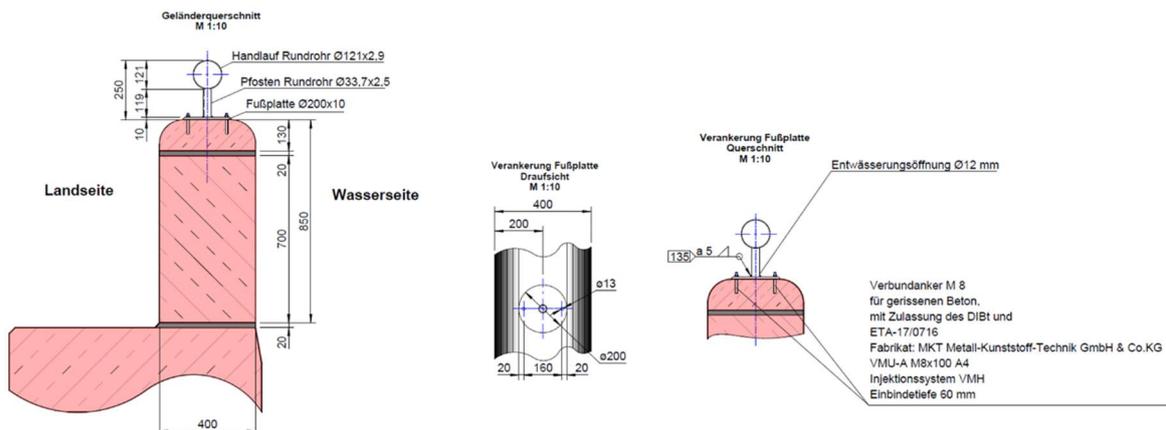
Querschnitt und Draufsicht des Rundrohrs auf der Stahlbetonmauer, bearbeiteter Auszug aus Plan G 01b der Werkszeichnungen [U.7]
